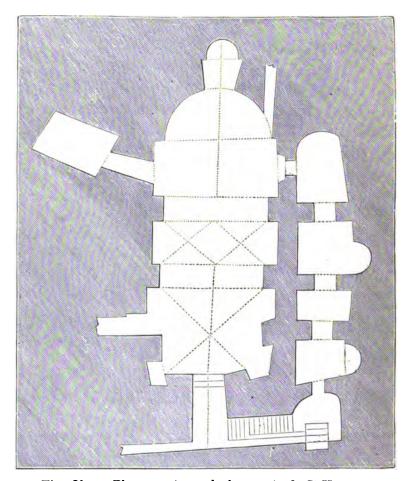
Plan par terre de la crypte de St-Hermes.
